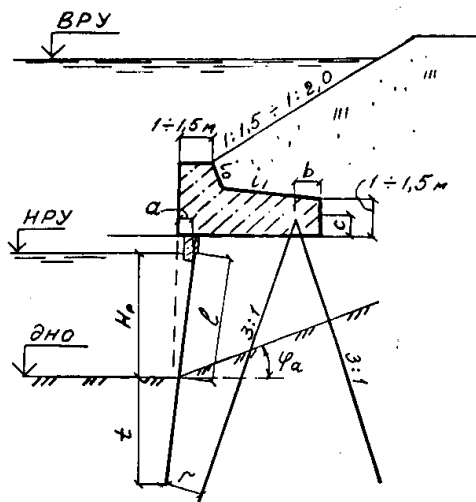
Откосная набережная с бетонным ростверком и передним шпунтовым рядом
